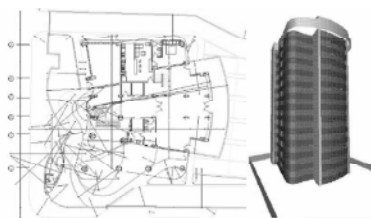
Planta y modelo renderizado de las residencias Lago Cristal en Maracaibo (Vargas, Cuberos, 1995)
